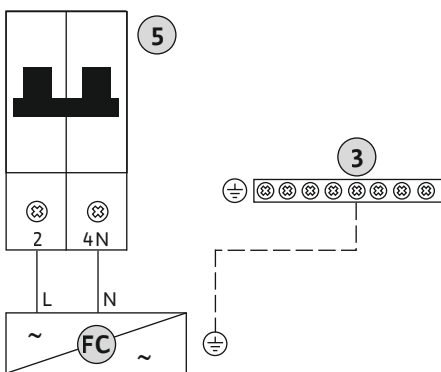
Forbindelse av pumpe med 2-polet skillebryter
